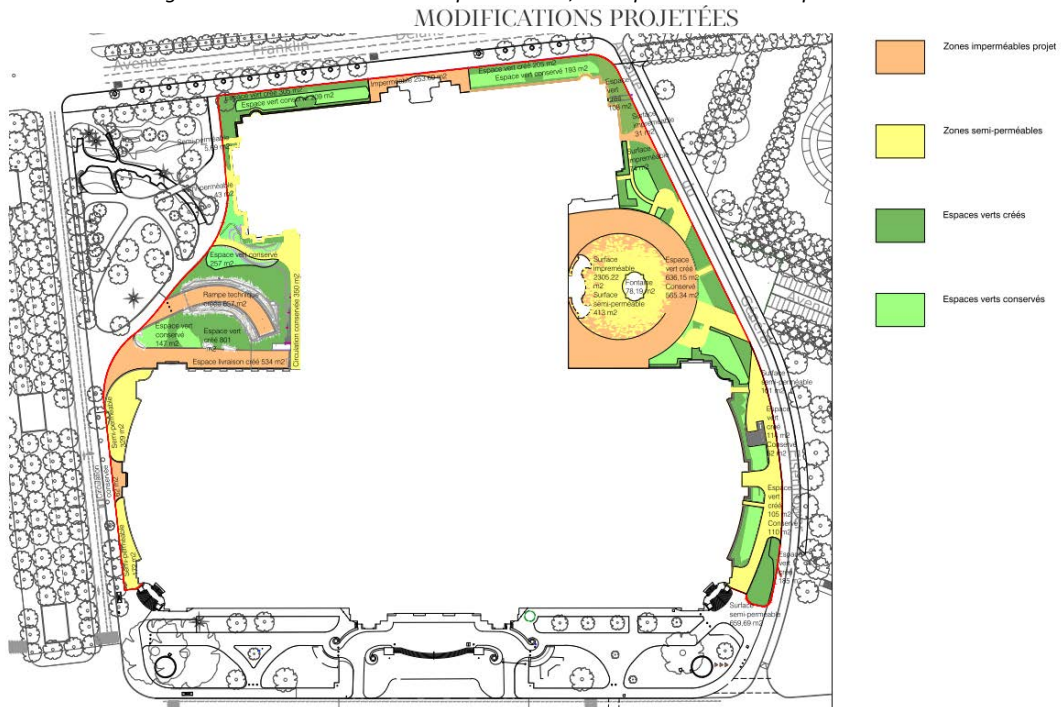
Plan du projet des zones perméables, semi-perméables et imperméables, aucune modification apportée sur l'avenue Winston Churchill
